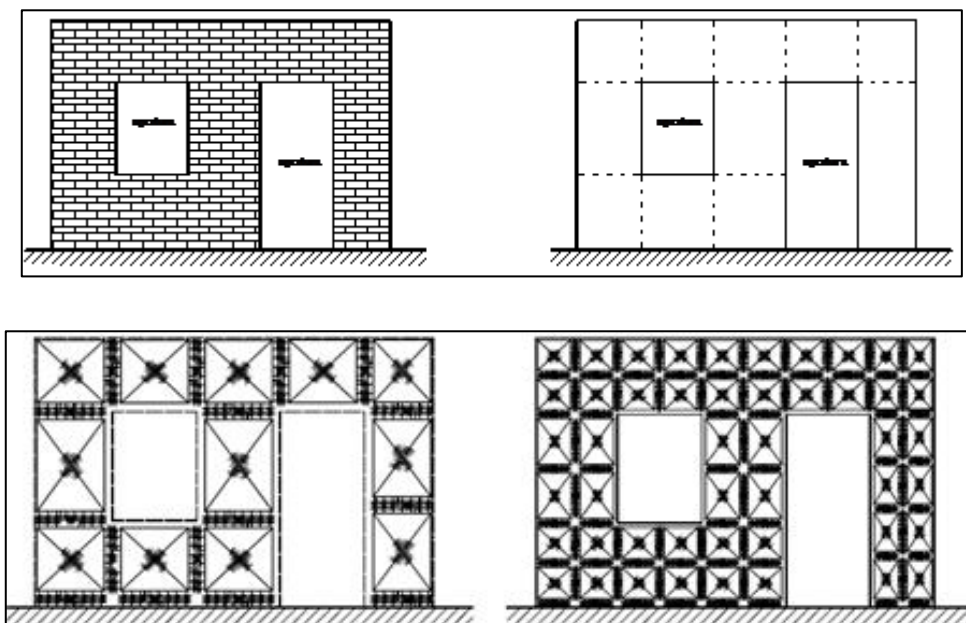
Modelado de una pared de mampostería de ladrillo. Fuente: Tomado de Gruppo Sismica (2014).
